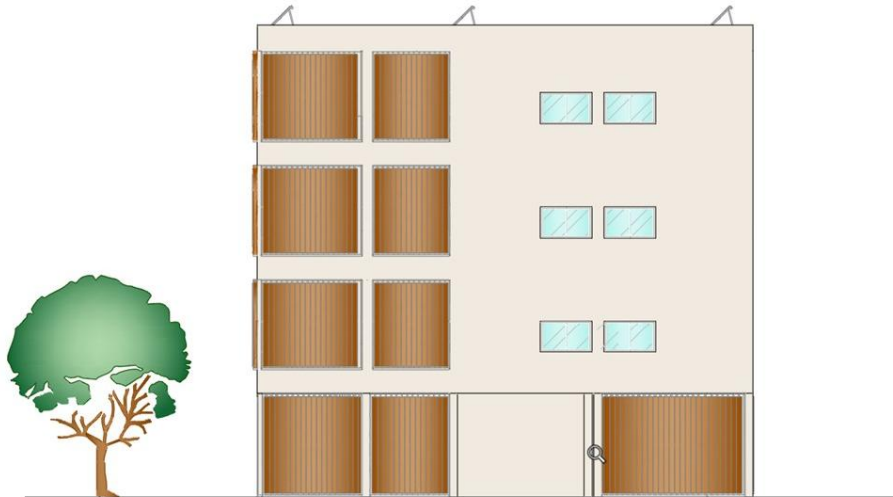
Vista em alçado da fachada oeste (fachada principal)
